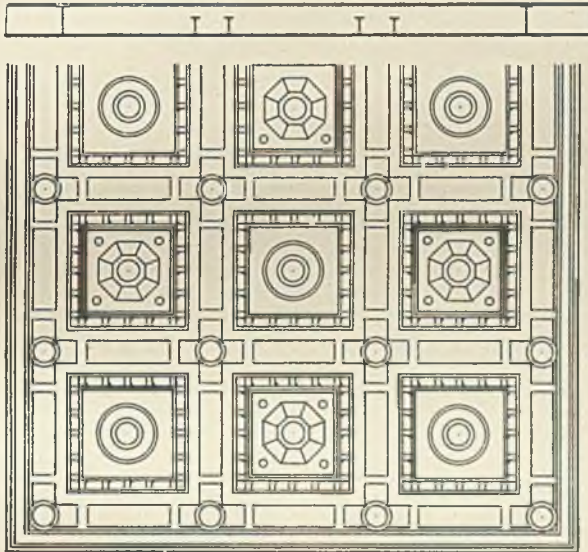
^b Schnitt u. Grundrifs der Decke 1:100
